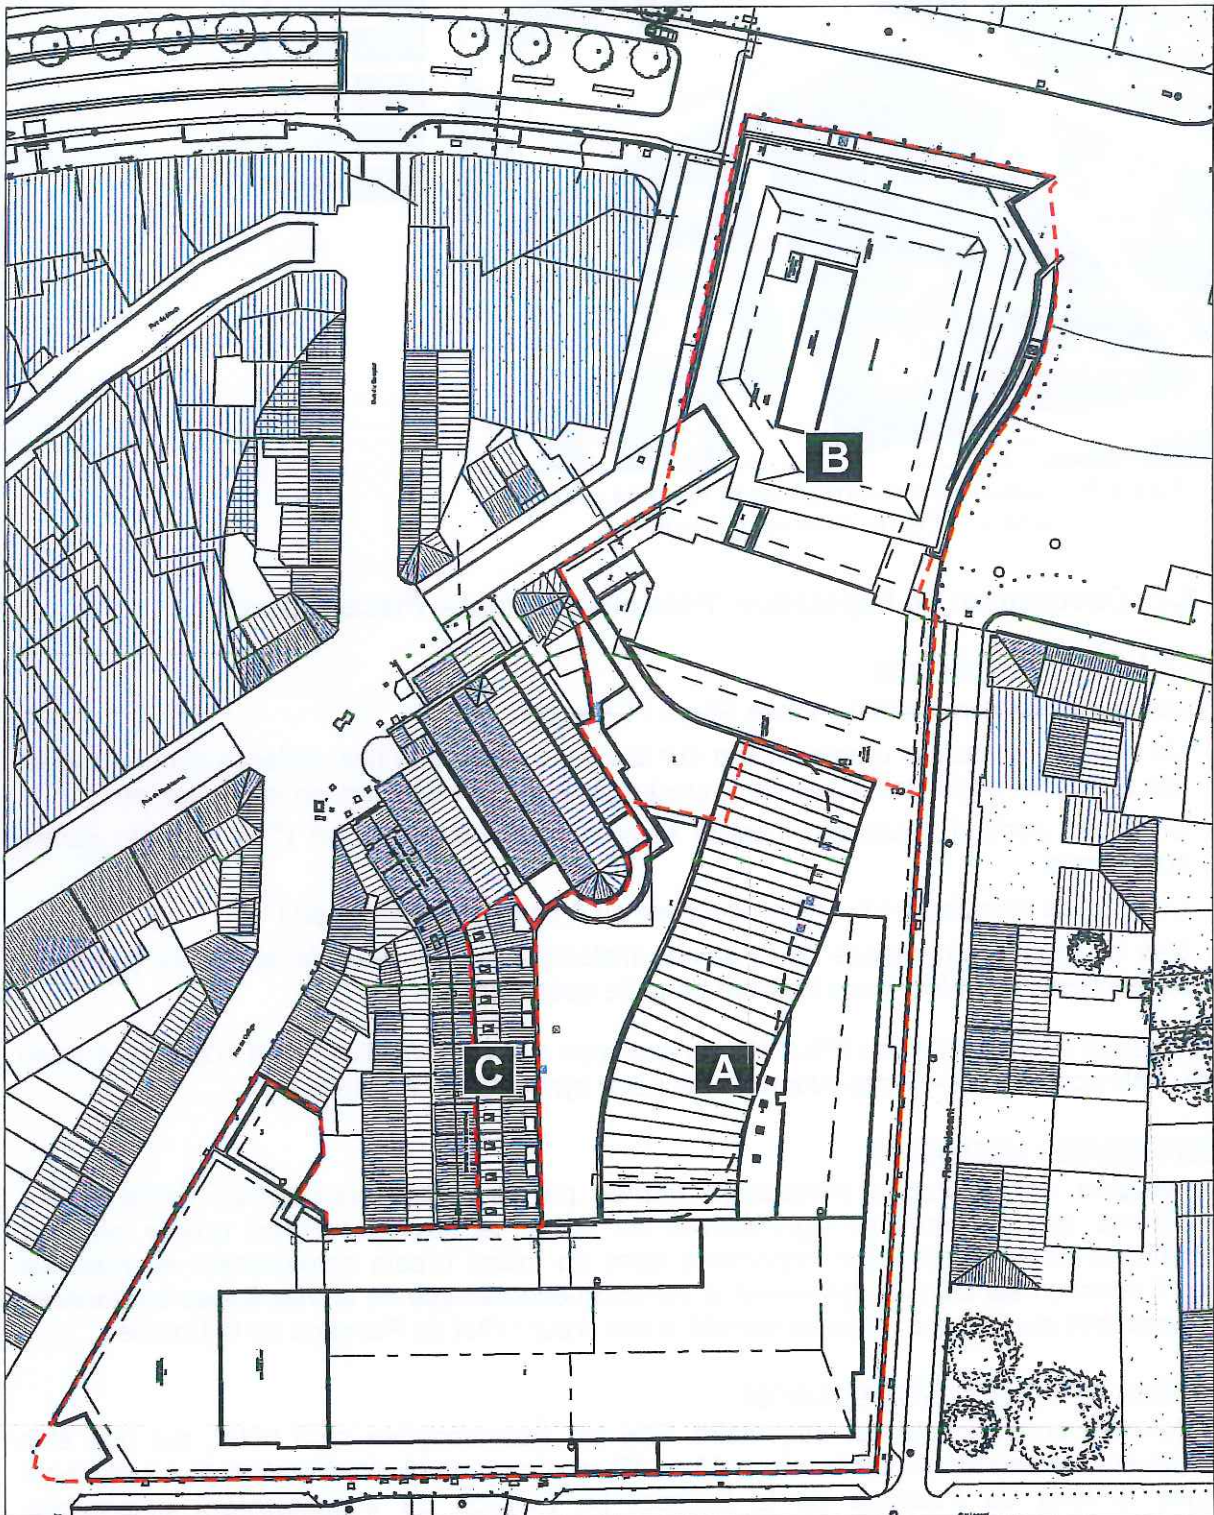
Plan général du projet Rive Gauche, sur lequel les toitures existantes non modifiées sont hachurées (source : plan de toitures, DDS & Partners Architects, avril 2011)
